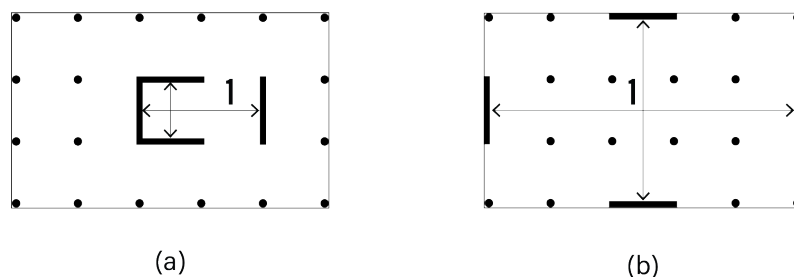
Dy planimetri të katit përdhe të ndërtesave. Në (a) forcat e tërmetit në çdo drejtim, tërthor dhe përgjatë ndërtesës, rezistohen nga dy mure të vendosura në mënyrë të arsyeshme simetrike. Muret janë të ndara (1) por jo shumë. Megjithatë, në (b) muret që veprojnë në çdo drejtim kanë ndarje maksimale (1) dhe kështu sigurojnë kontrollin më të mirë të rrotullimit.
